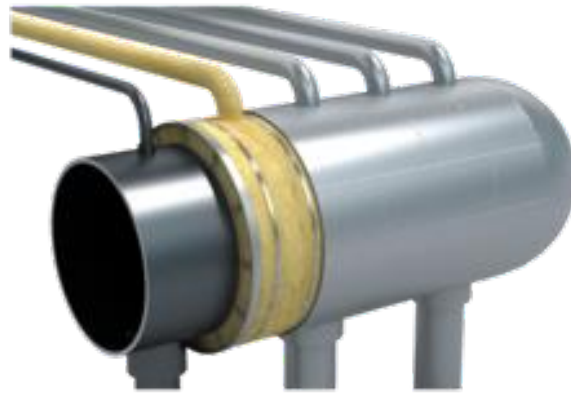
Система теплоизоляции промышленного оборудования ТН-
